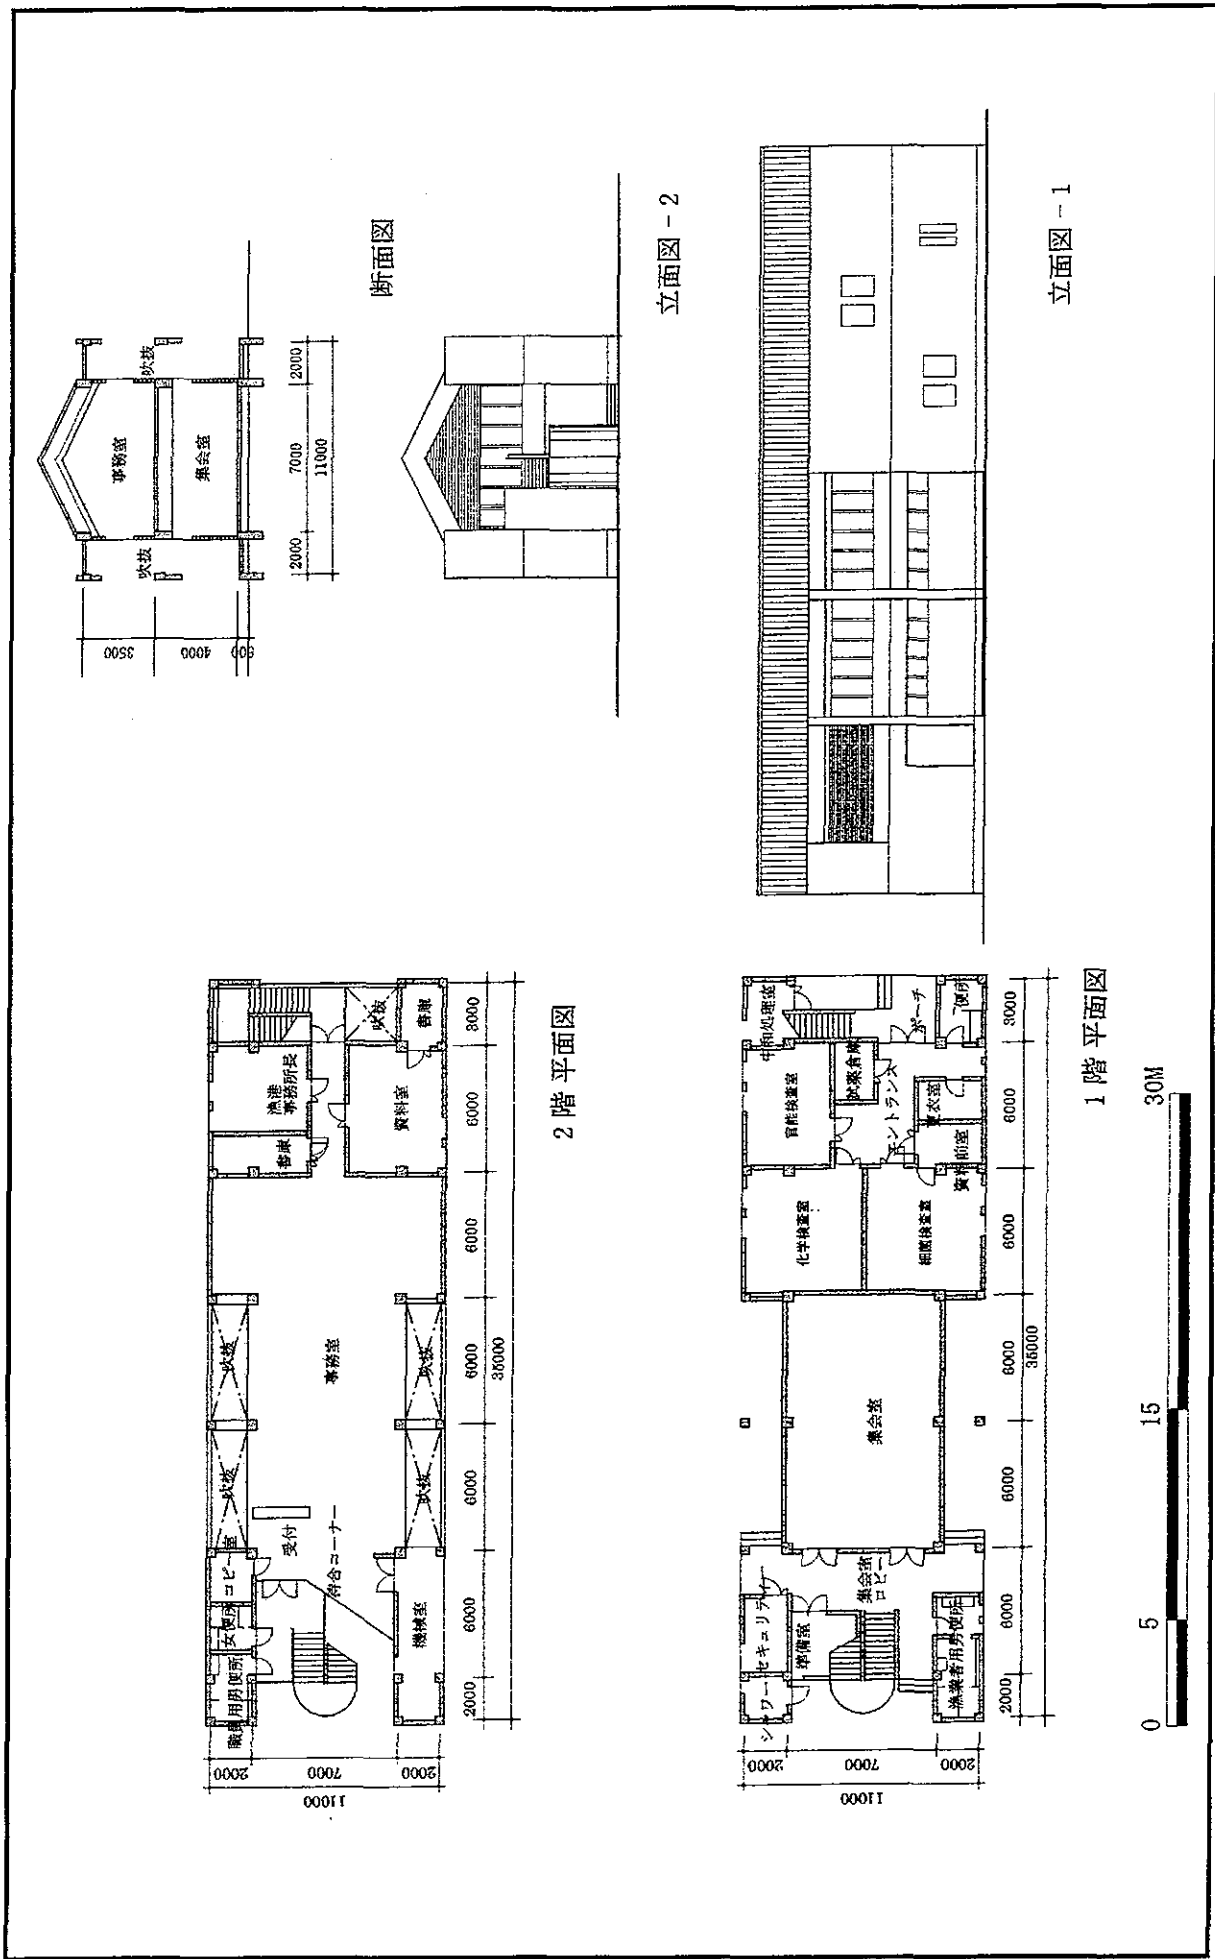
(8) 管理事務所(衛生検査ラボ・集会室)棟平面図・立面図・断面図
